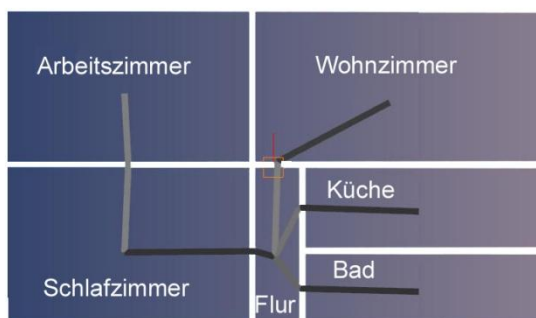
Grundriss und Rohrleitung für Erdgeschoss und Obergeschoss
